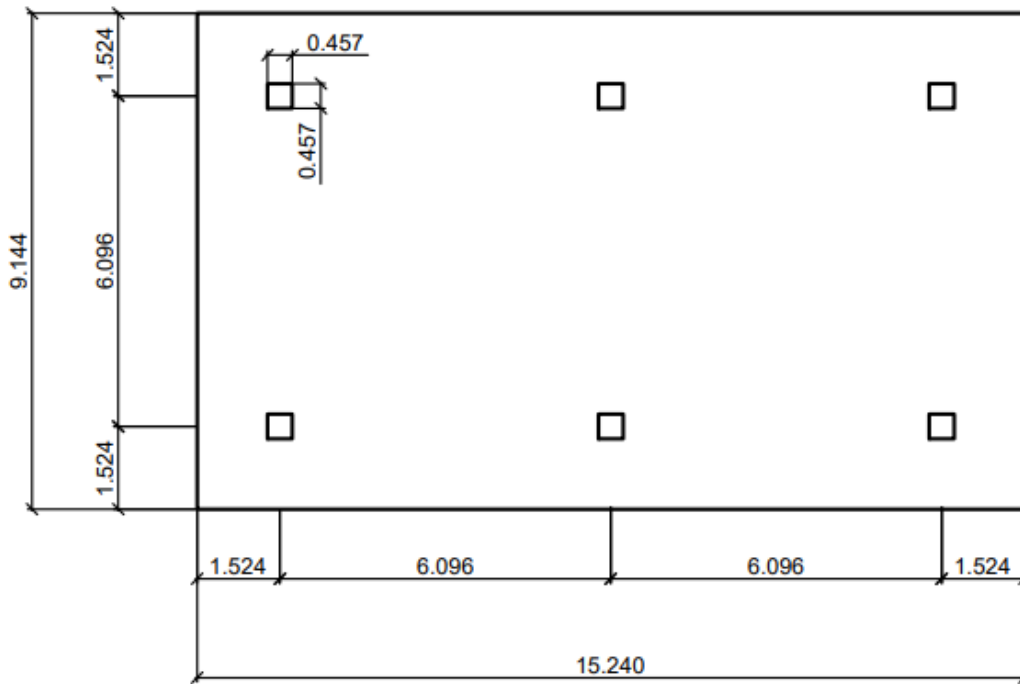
Planta de formas da estrutura, com cotas transformadas para o Sistema Métrico, com dimensões em metros. Adaptado de Fick (2008).
